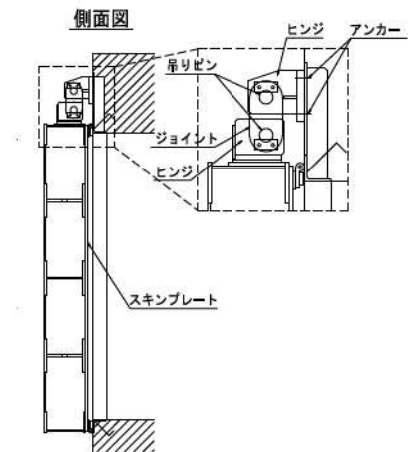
屋外排水路逆流防止設備構造例（断面図）
